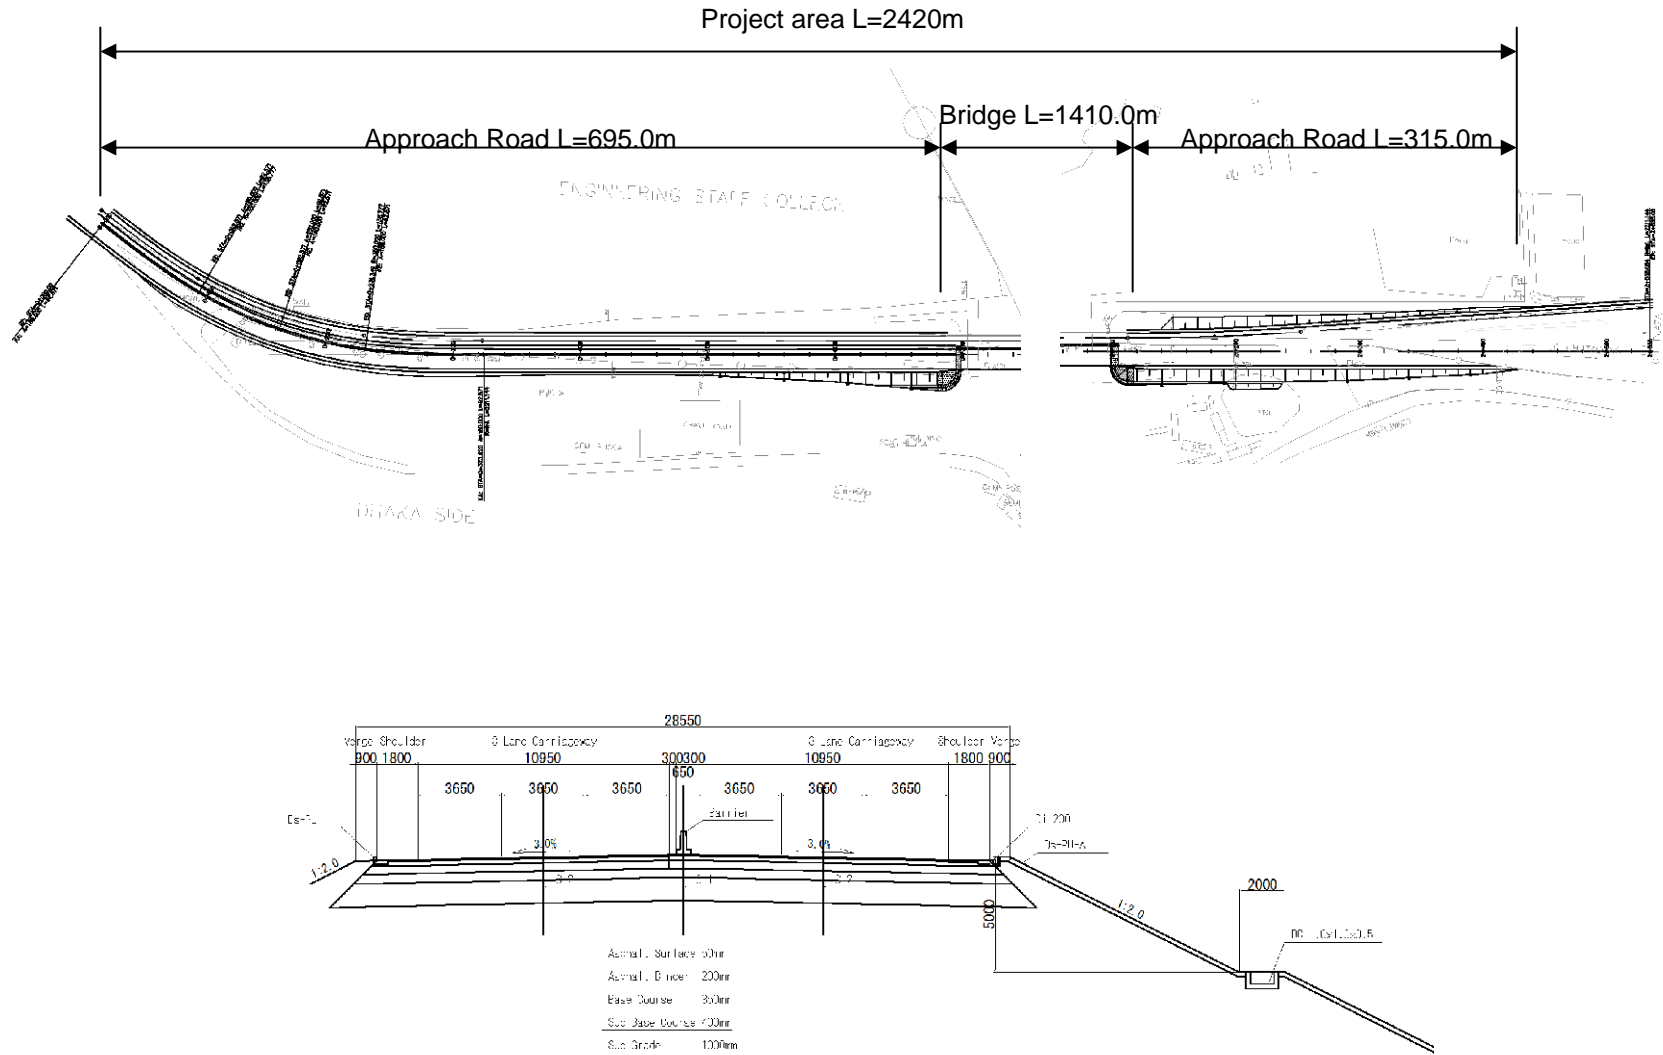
平面図、標準横断面図 (第2グムティ橋)
